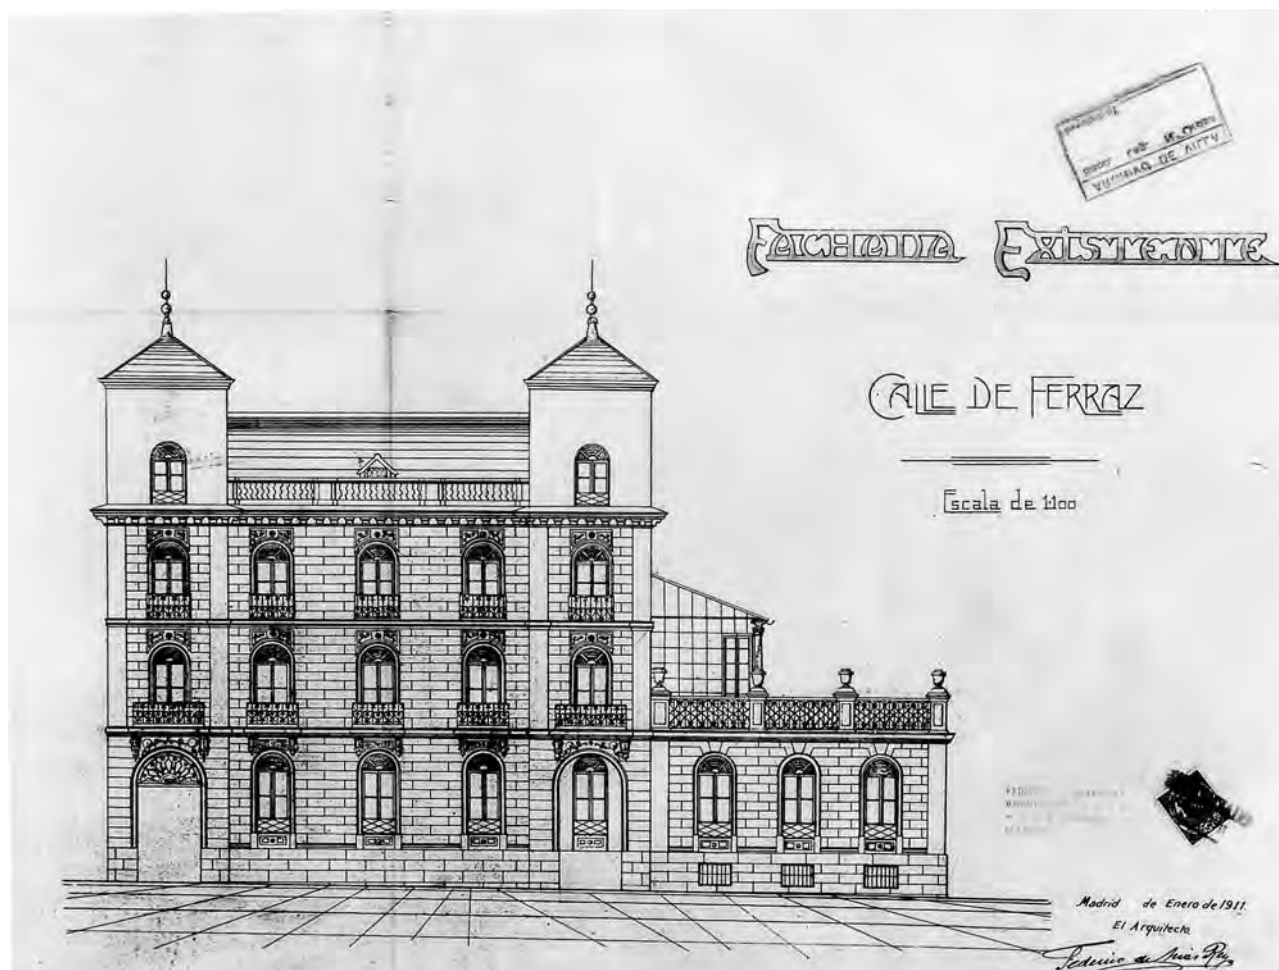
Alzado de la “fachada existente” hacia la calle de Ferraz, enero de 1911. Arquitecto: Federico de Arias Rey. AVM: 18-141-2, 19-70-32 y 32 bis.
